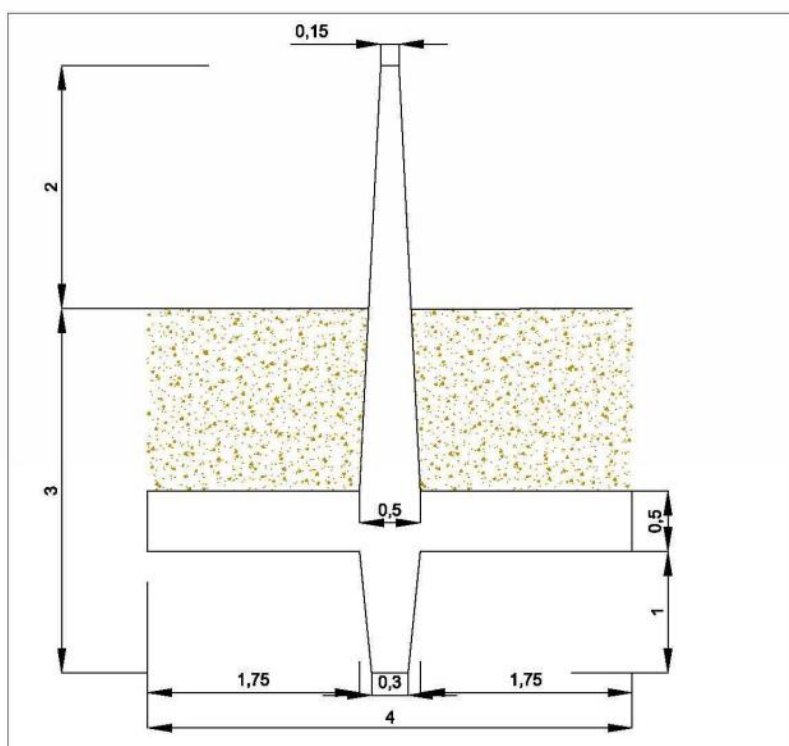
Geometria di progetto del Muro di contenimento – Tipologico muro interno
